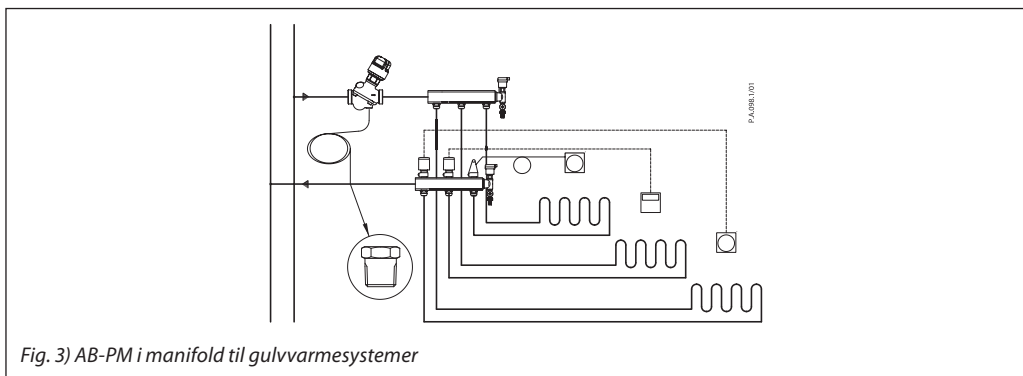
AB-PM i manifold til gulvvarmesystemer
